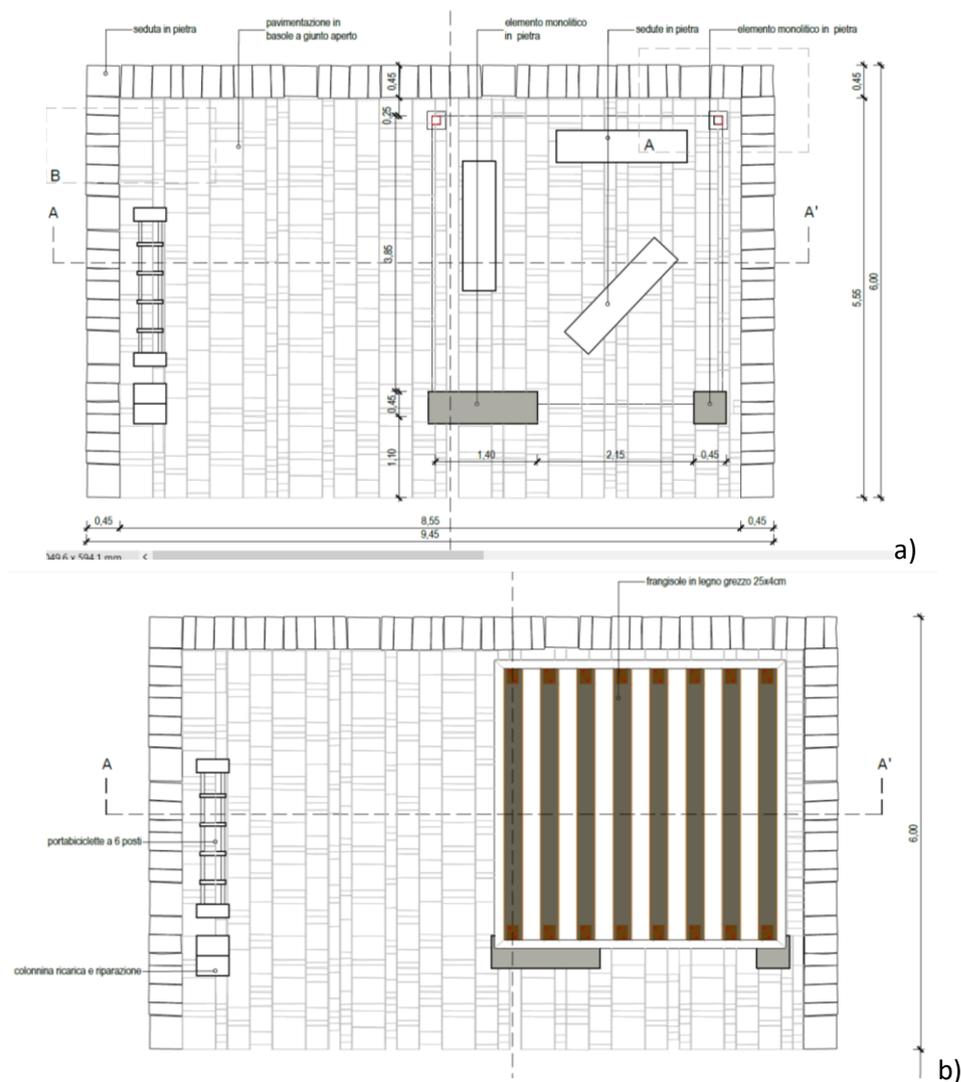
Tipologico area di sosta: sezione a) e vista dall'alto b)
